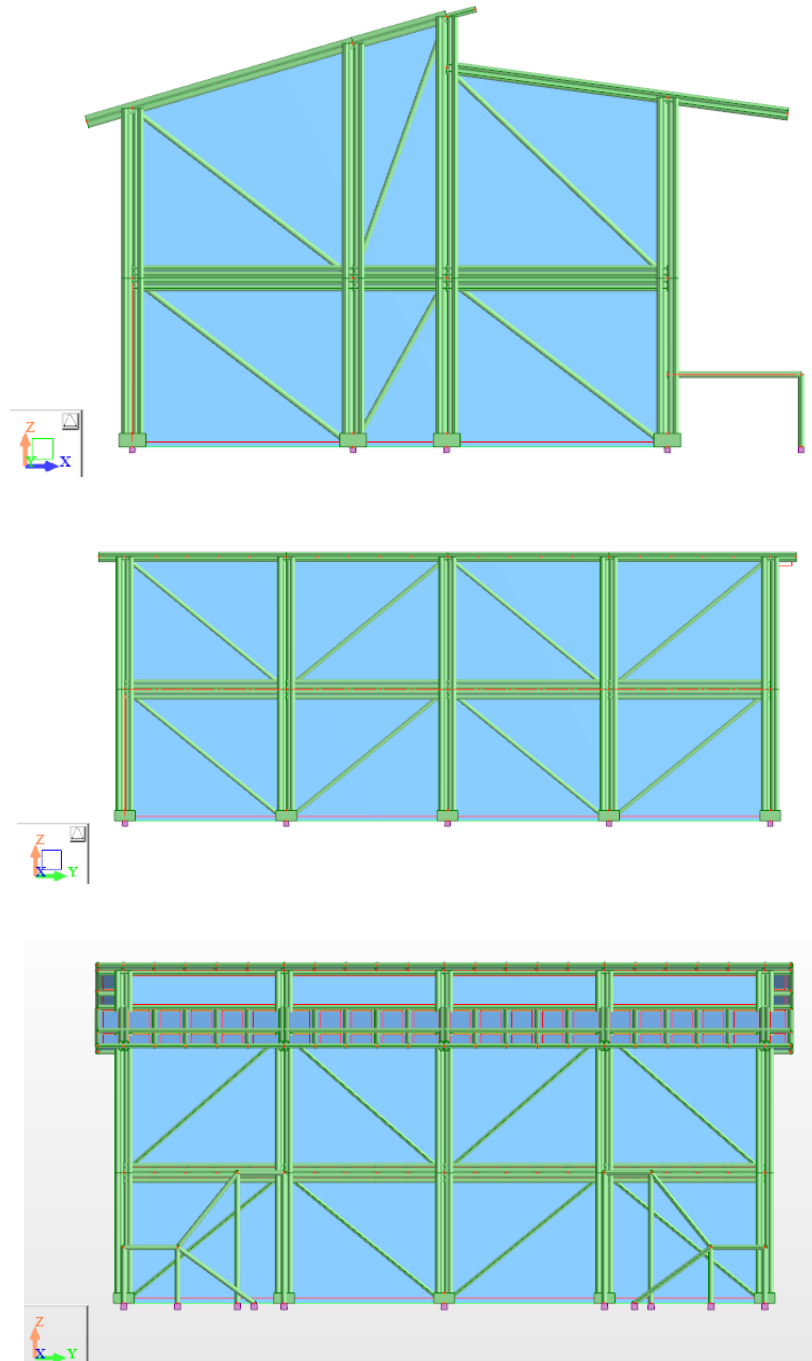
Disposición de diagonales en los paneles de la estructura. Vistas: lateral, eje 1 (plano xz), posterior, eje A (plano yz), frontal, eje D (plano yz).
